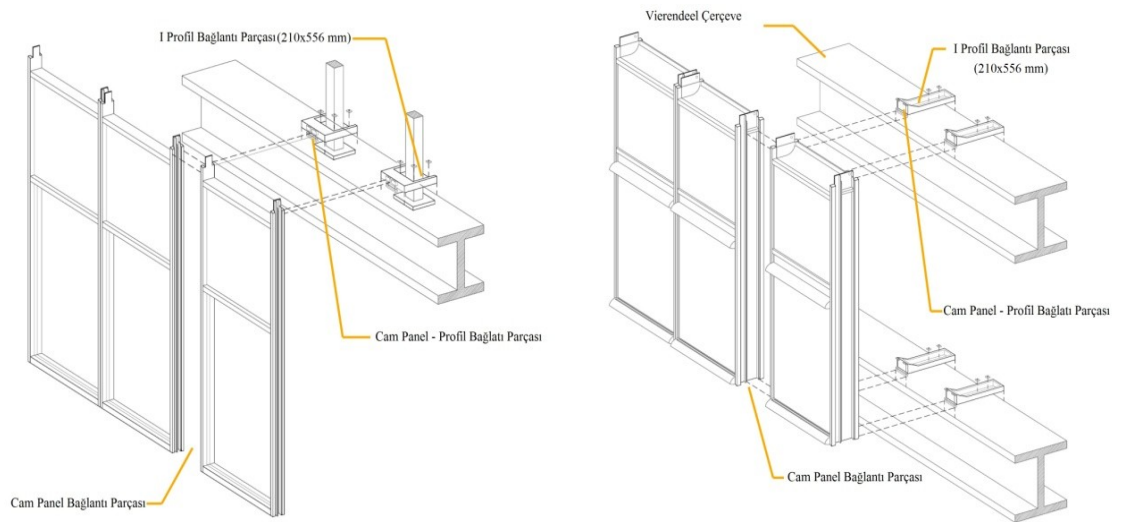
Commerzbank Binası prefabrik konstrüksiyon elemanları (Benkert)
